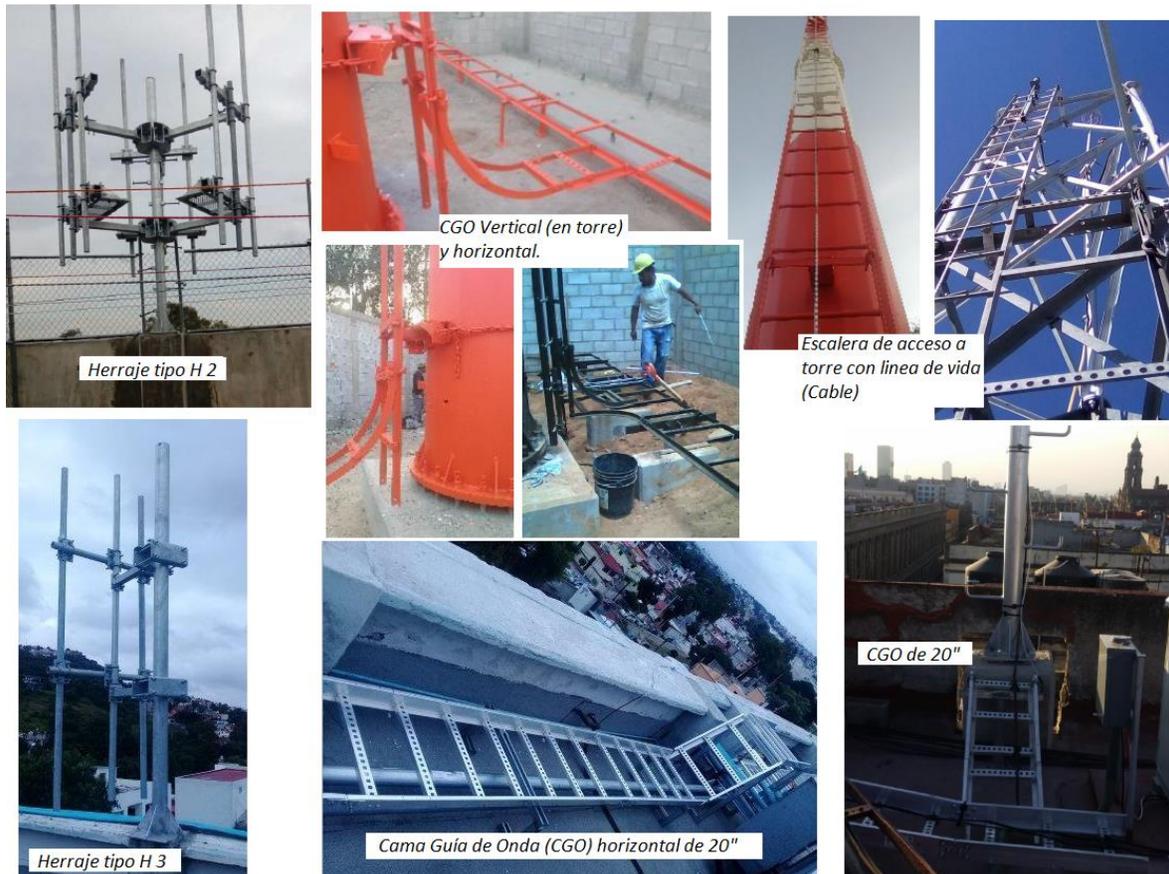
Herrajes, CGO, escalera y otros accesorios.
